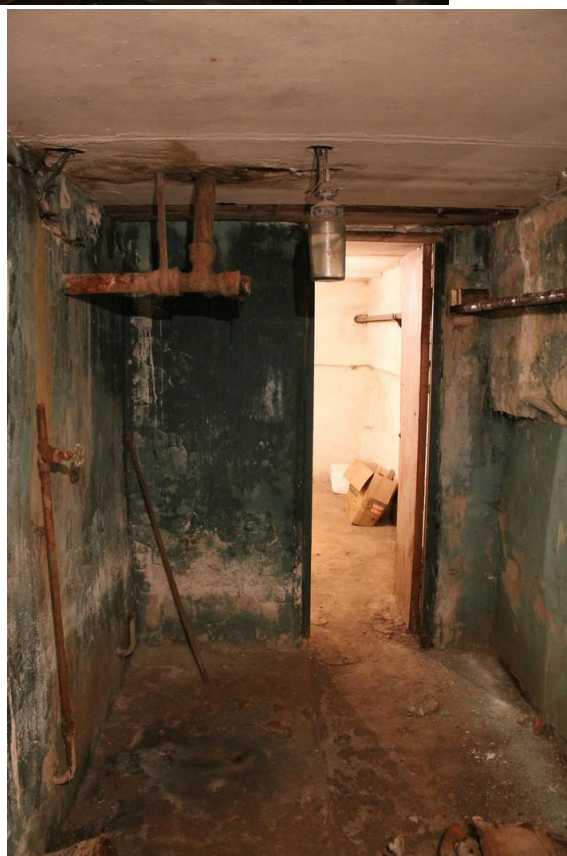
79. Подземный переход между помещениями ЗС ГО
